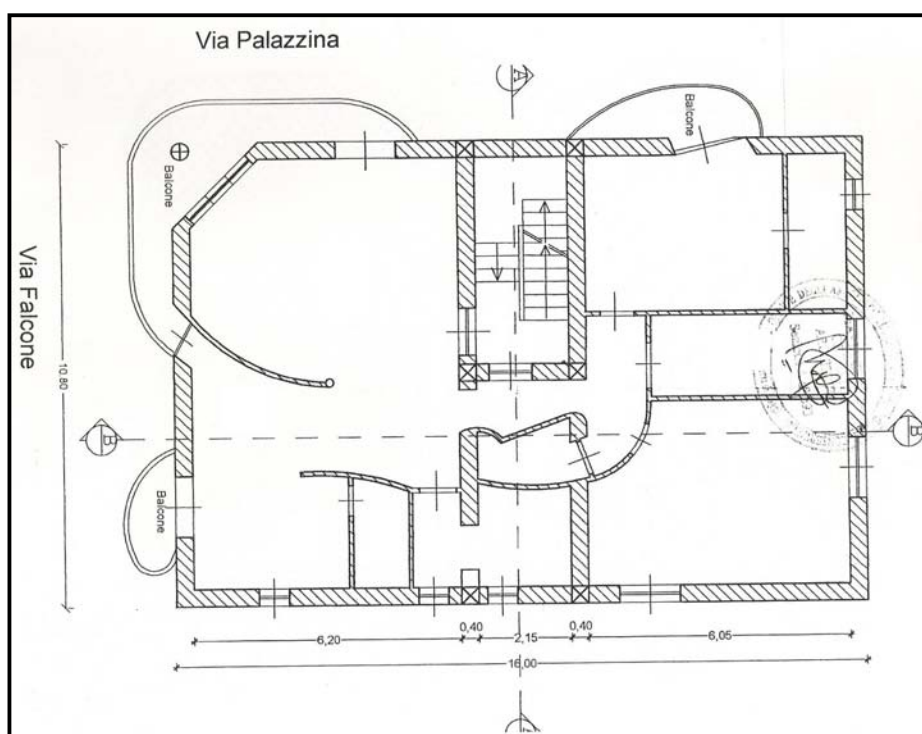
Appartamento al primo piano: planimetria dei locali.
